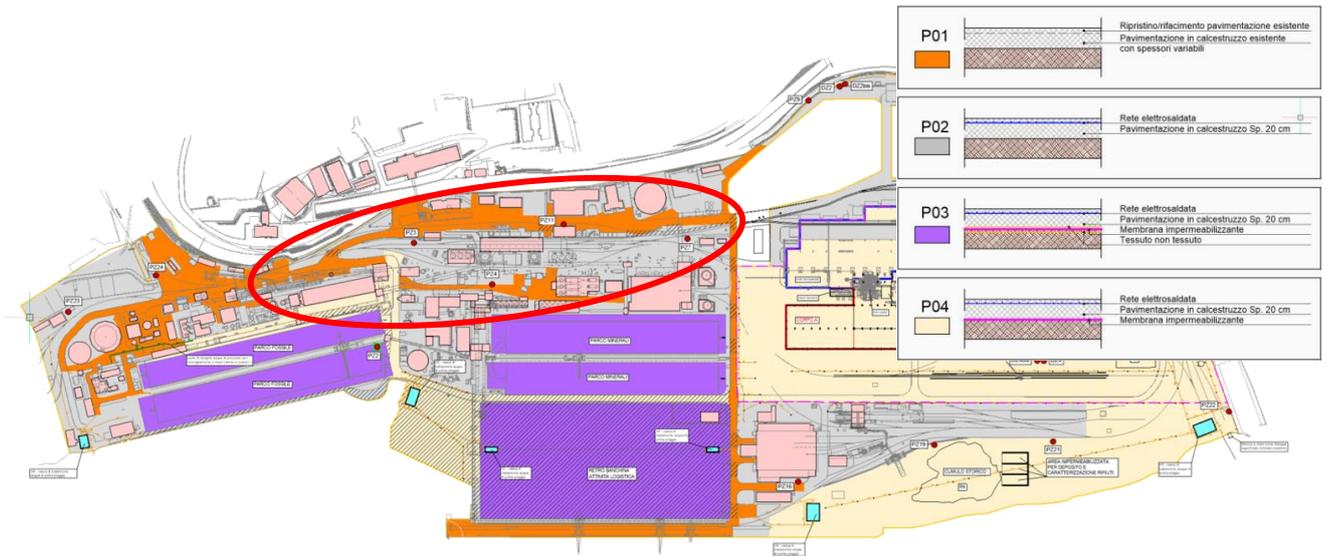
Planimetria di progetto della MISO di Siderurgica Triestina del 2015 e schemi tipologici delle pavimentazioni previste. Preme evidenziare come nell'area di cui si tratta fu giudicato sufficiente realizzare nuovi pavimenti in c.a. o ripristinare quelli esistenti (tipo P01 e P02) senza una membrana specificatamente interposta. Tutti gli edifici evidenziati in rosa nella immagine sono stati demoliti a livello del loro attacco a terra per effetto del progetto delle demolizioni di cui al decreto 522/2021. L'ovale rosso indica l'area delle opere rispetto alle quali si esprime la presente istanza.
